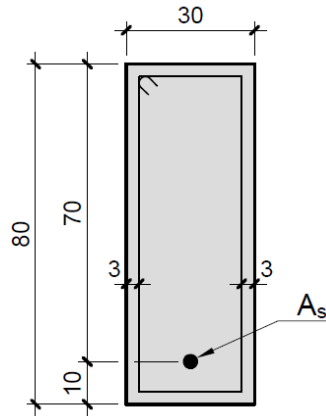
Seção transversal da viga padronizada (cotas em centímetros)
